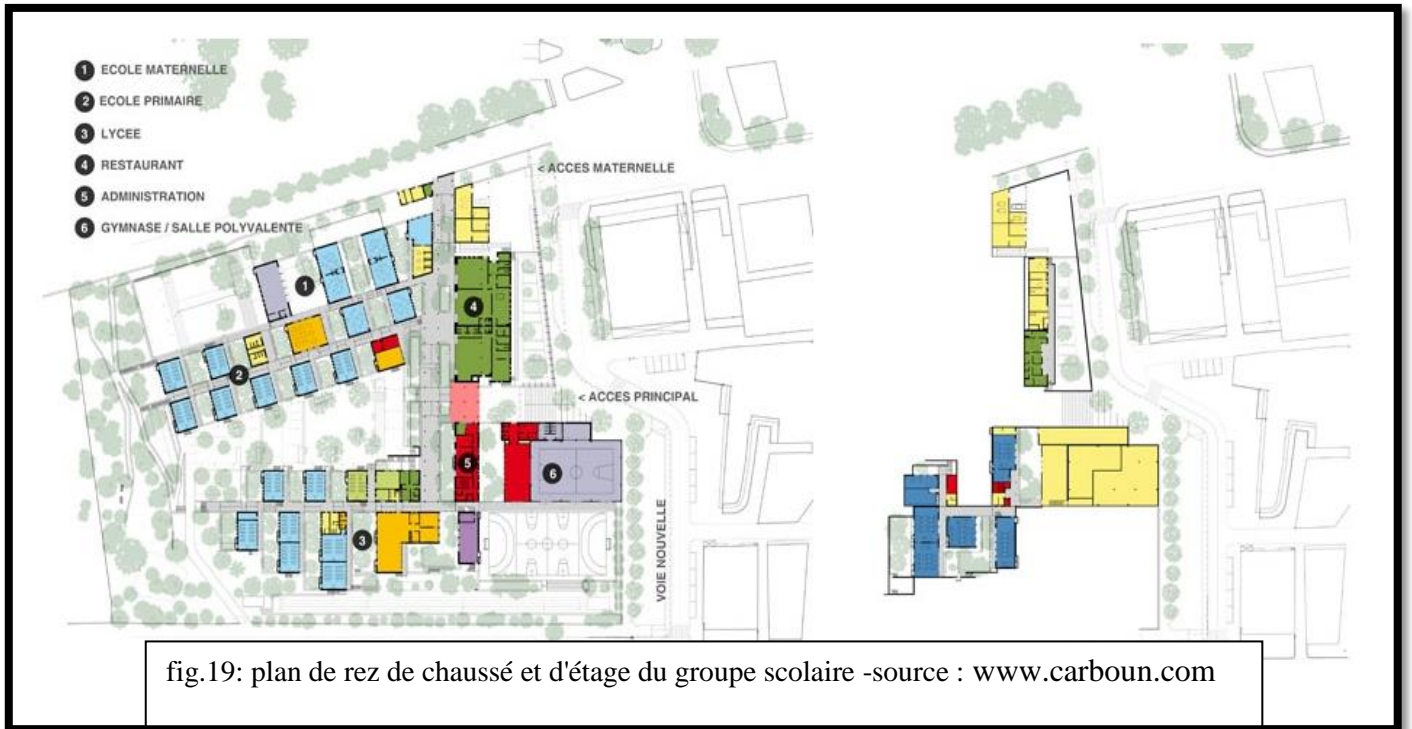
plan de rez de chaussé et d'étage du groupe scolaire -source : www.carboun.com
